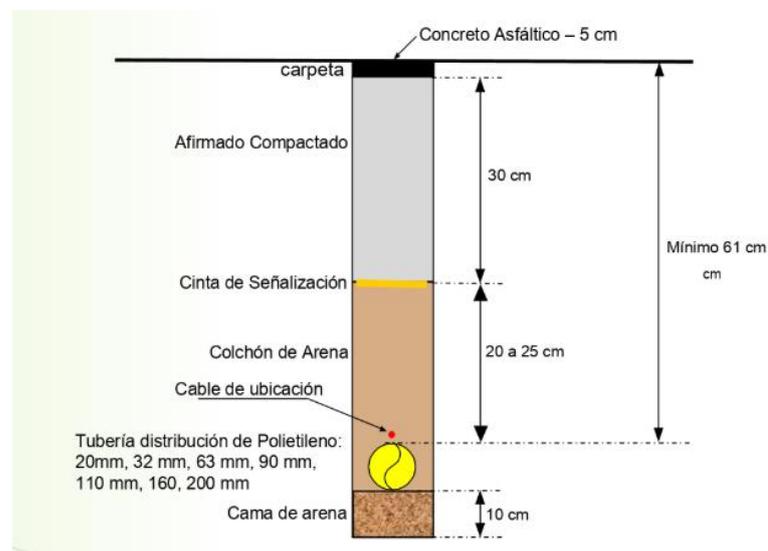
Detalle de corte transversal de instalación de tubería de RDGN.
